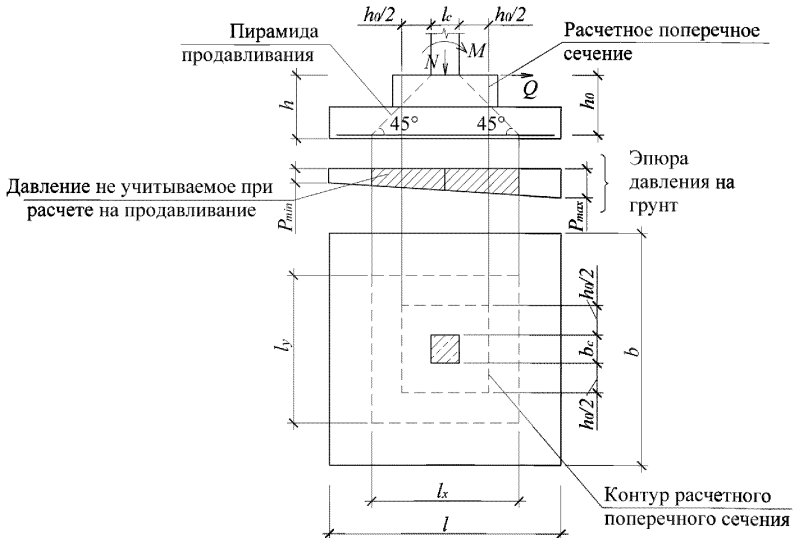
Схема для расчета фундамента на продавливание
